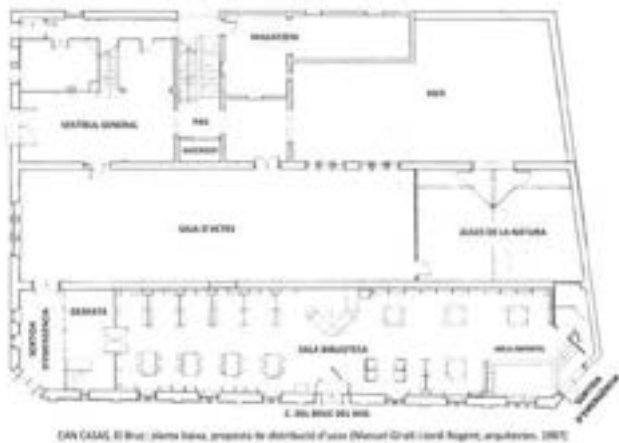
Can Casas, proposta planta baixa. Giralt-Rogent, arquitectes, 1987, Arxiu GR
